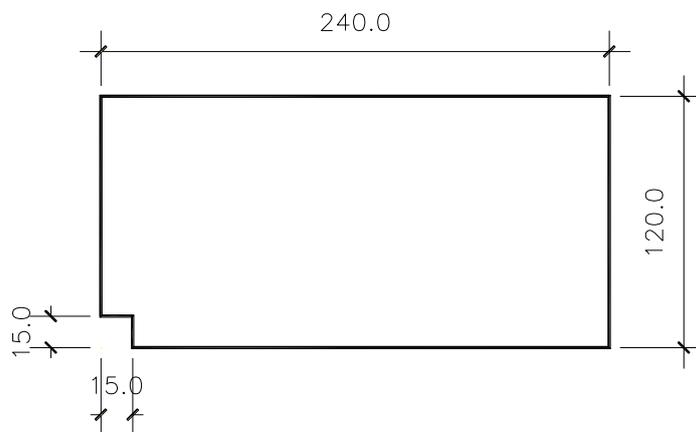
Planta da laje pré-moldada - medidas em centímetros
